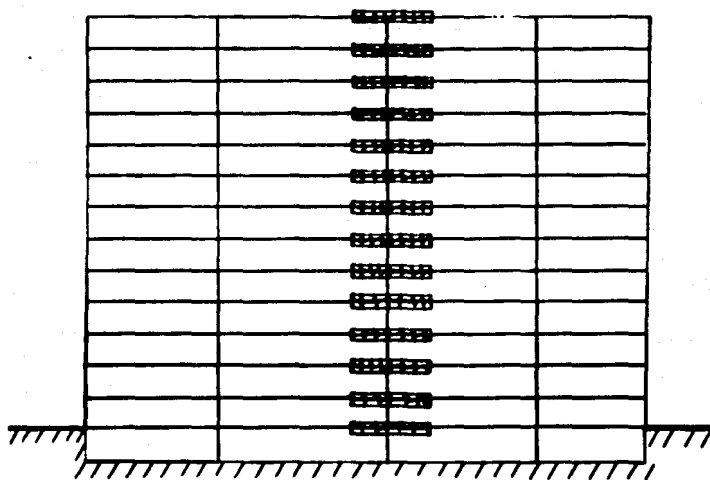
Idealización del muro de concreto en base al concepto de columna ancha.
